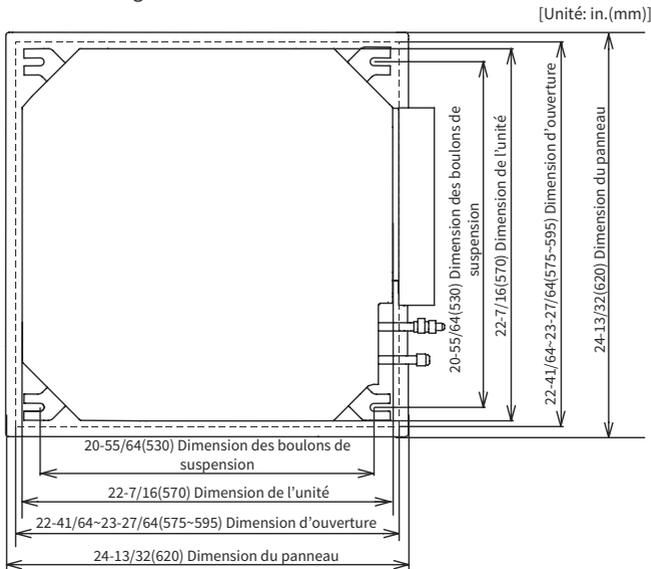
Ouverture dans le faux plafond et tiges de suspension
